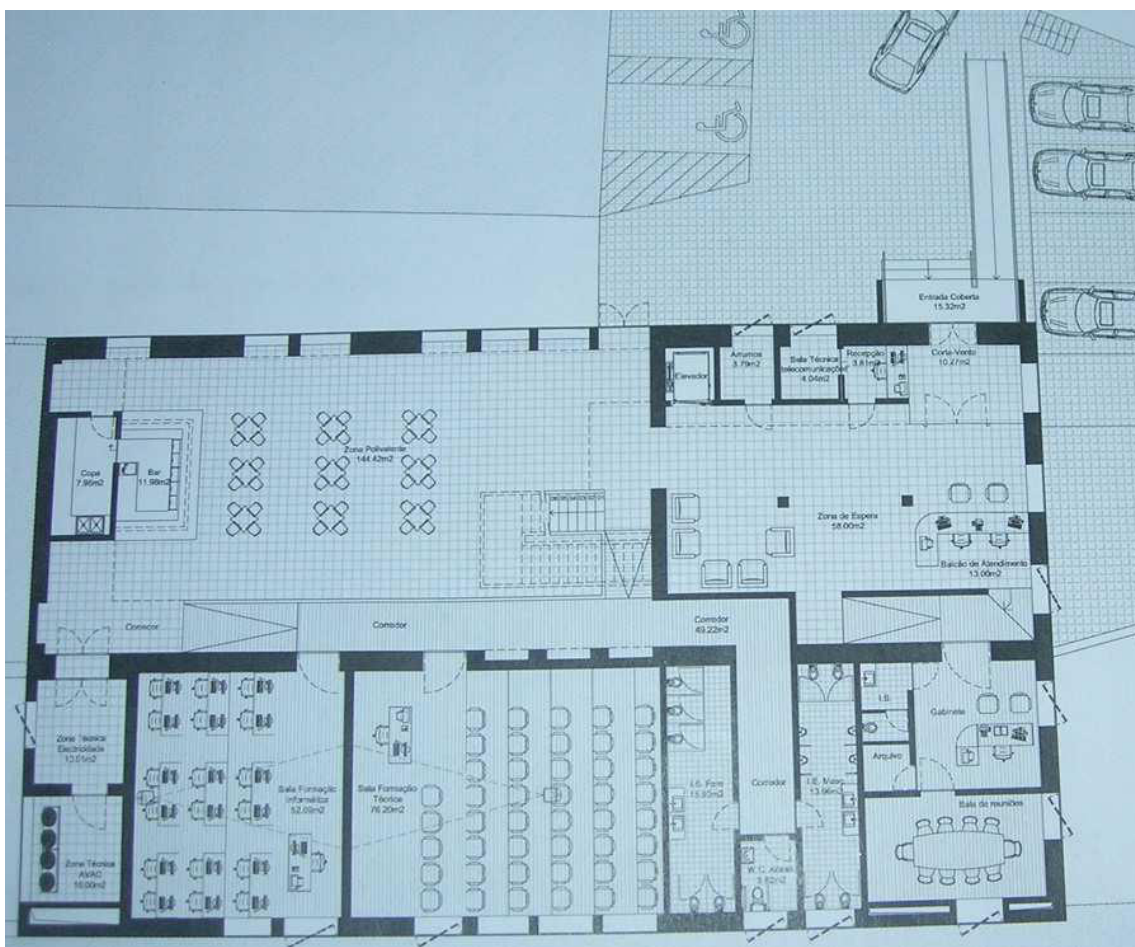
Planta da proposta para o piso do r/chão – “Ninho de empresas”
